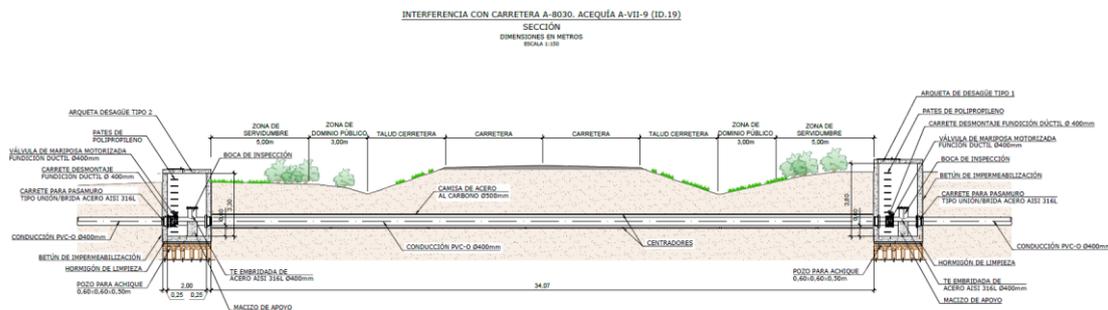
Sección tipo de cruce de tubo bajo carreteras
